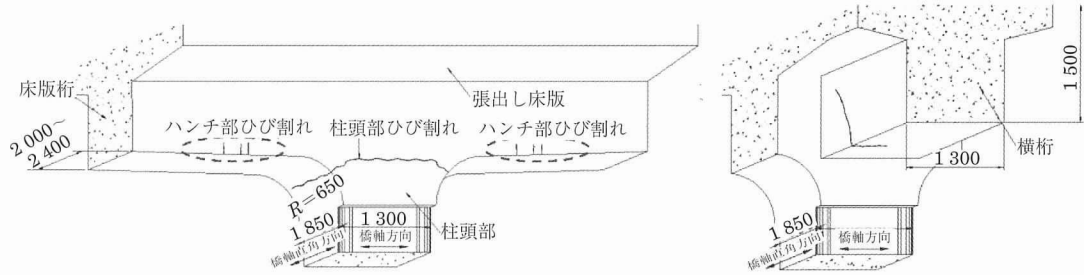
柱頭部および柱頭部横桁のひび割れ状況
